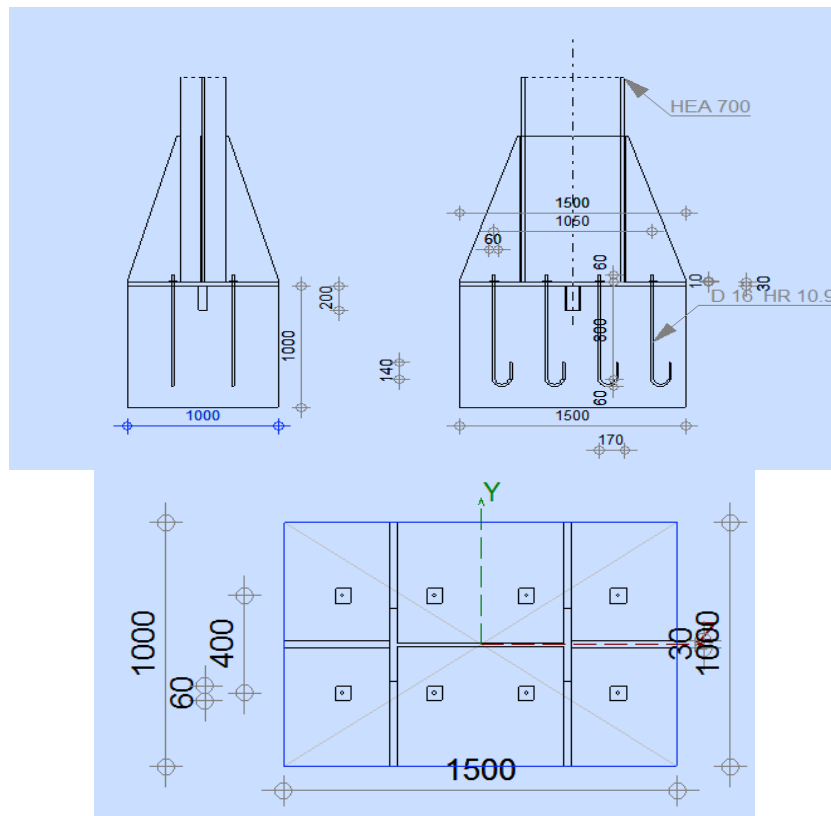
Schéma statique des pieds de poteaux (HEA700).
